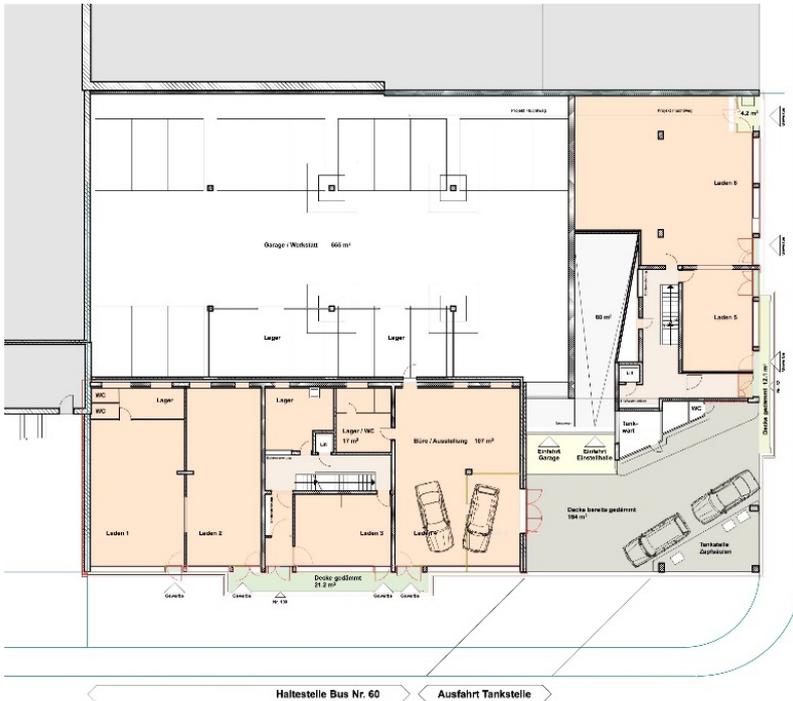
MFH Dornacherstrasse Basel , Grundriss Erdgeschoss, Gewerbe / Tankstelle und Garage
